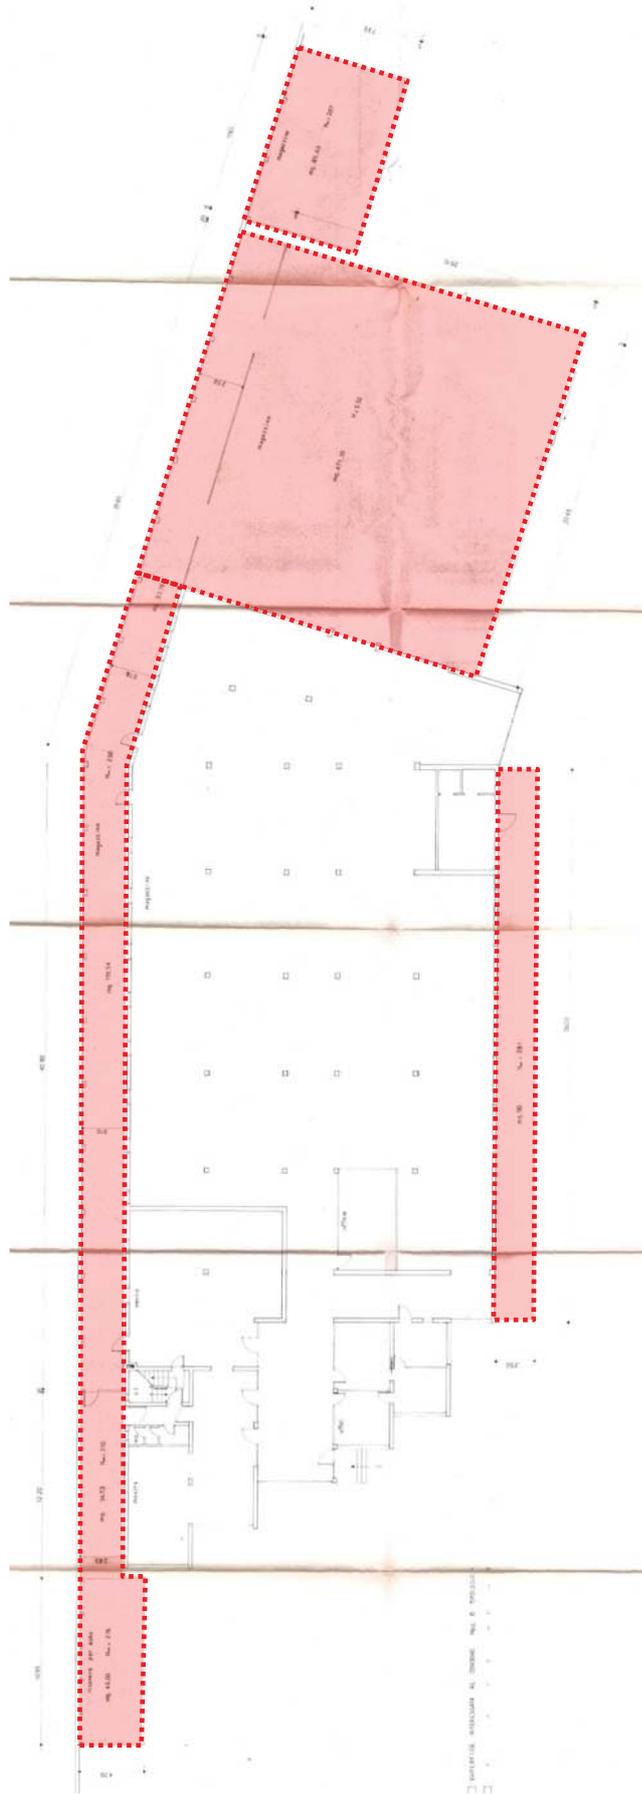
estratto (*fuori scala*) pianta piano terra C.E. in sanatoria Prot. gen. n. 20880 bis-86 N.
